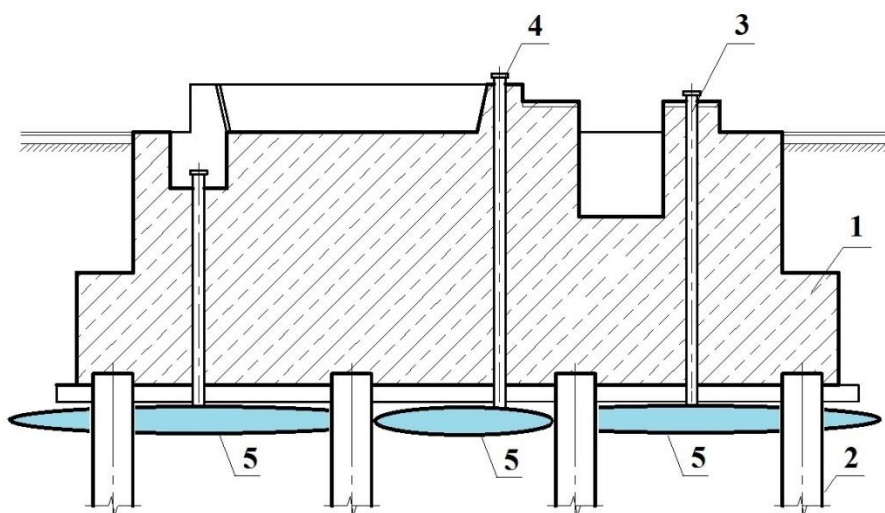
Схема усиления свайного фундамента под машину с динамическими нагрузками инъекцией раствора под подошву ростверка.
